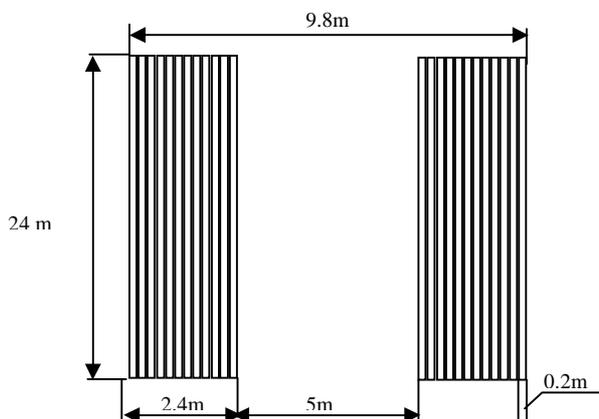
Distribución perfiles estructurales
